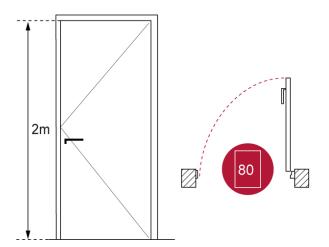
Ancho libre de puertas en los recintos de la vivienda
